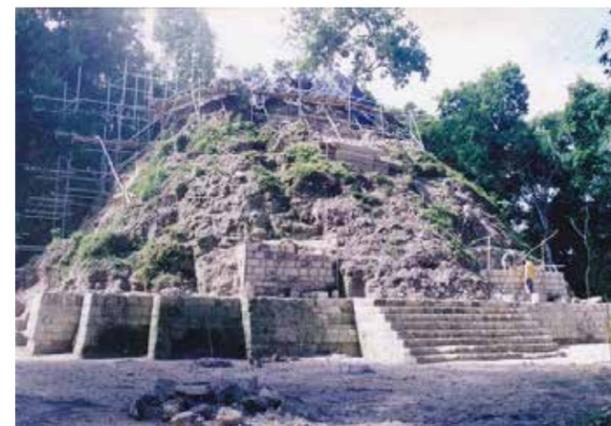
Edificio 1 Fachada este, descapote de cámara superior e integración de fachada de piedra en primer y segundo cuerpos. Foto: TLMC 2002
